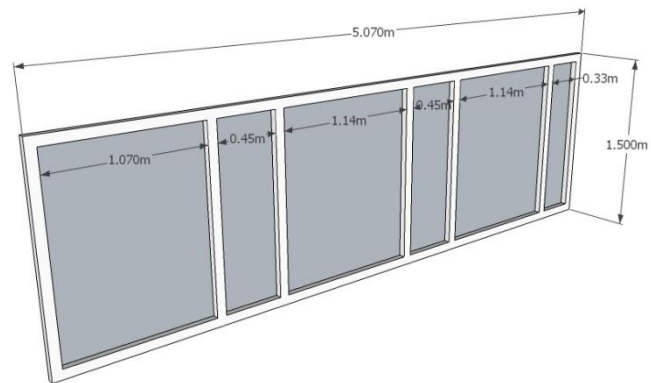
Ventana compuesta VC1. Primer piso, Fachada Norte.
